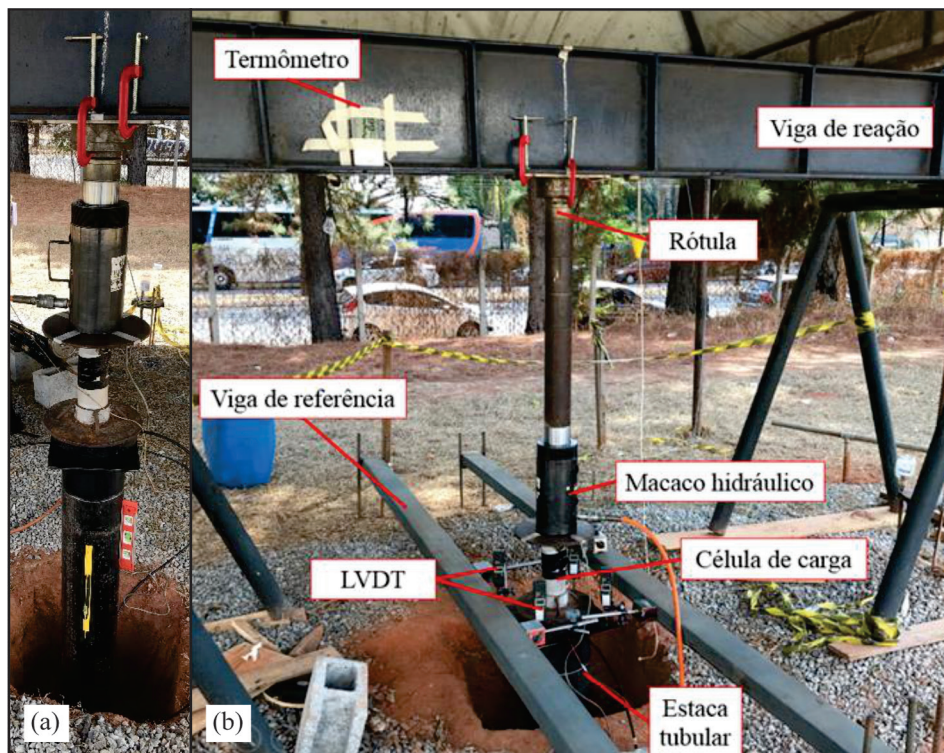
(a) prensagem da estaca metálica, (b) aparato da prova de carga. Adaptado de Galvani Jr (2020).
